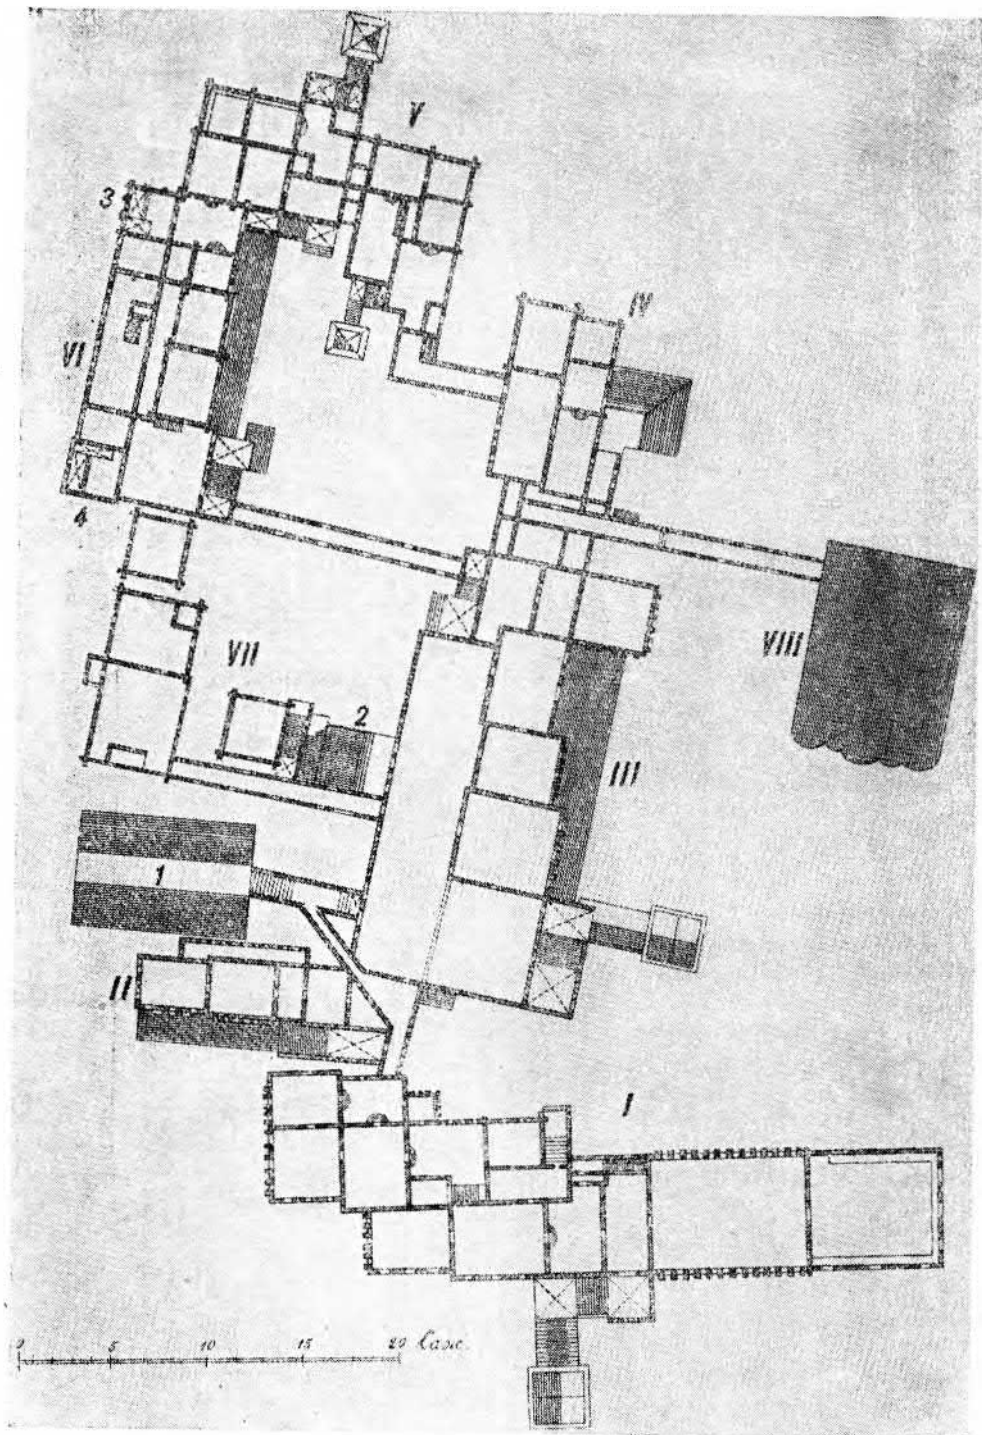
План верхнего этажа Коломенского дворца (И. Забелин).
